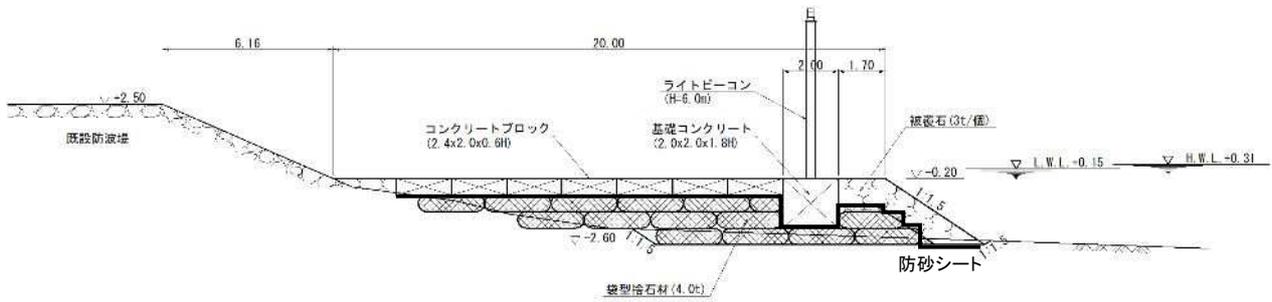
(5) 潜堤本體(完成時)の縦断面図
